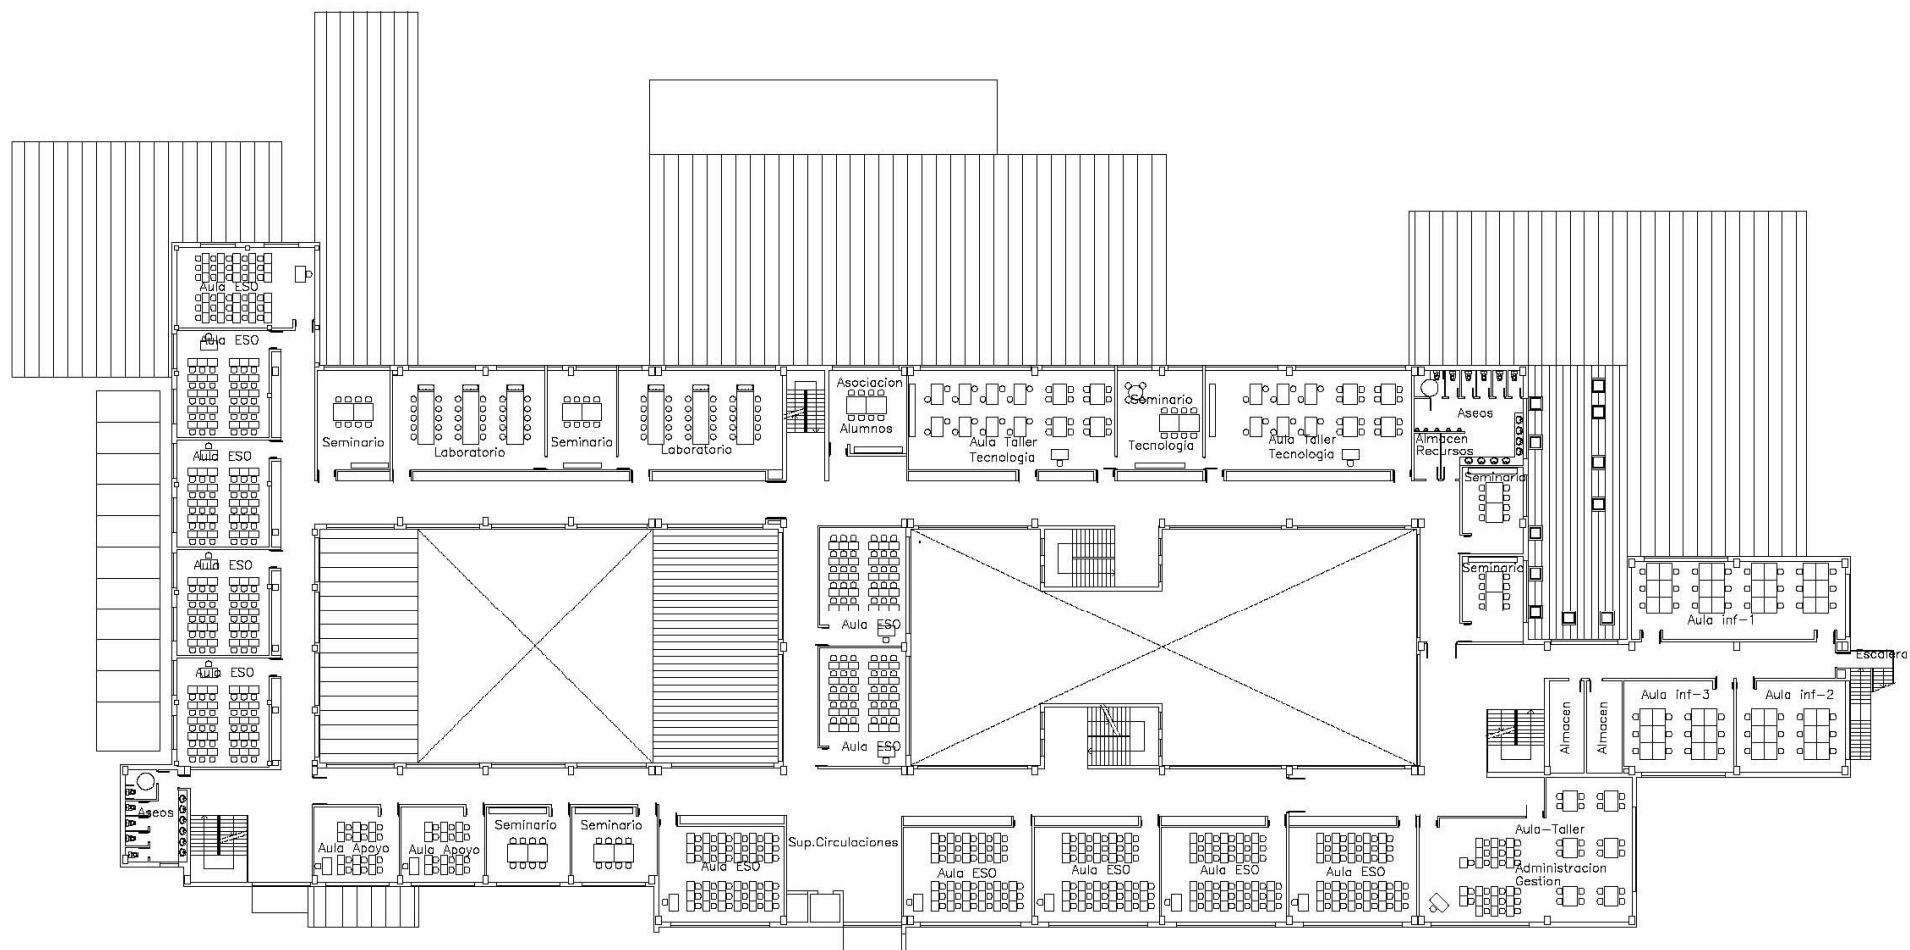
Plano de distribución Planta 1ª (Fuente: proyecto)
